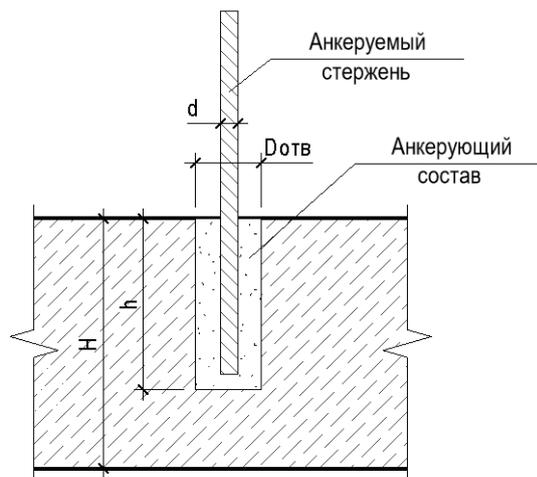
Схема анкерования арматуры и элементов крепления
